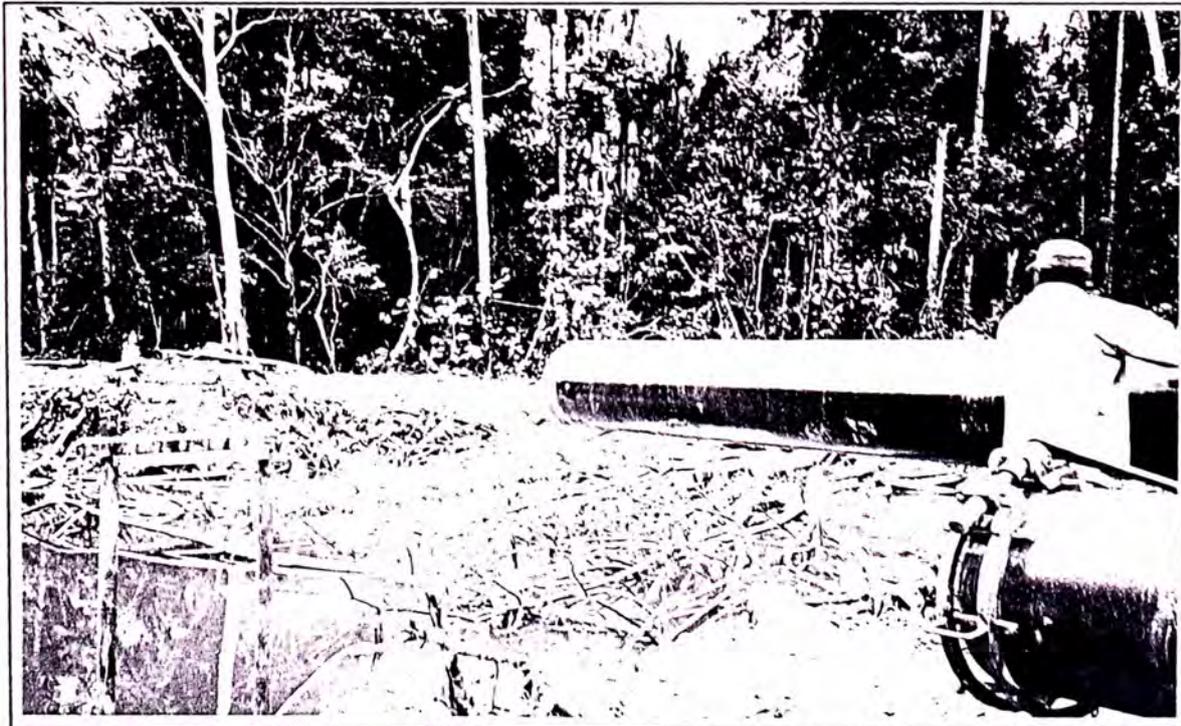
La tubería 29, 30 y 31 cruzando el canal.
